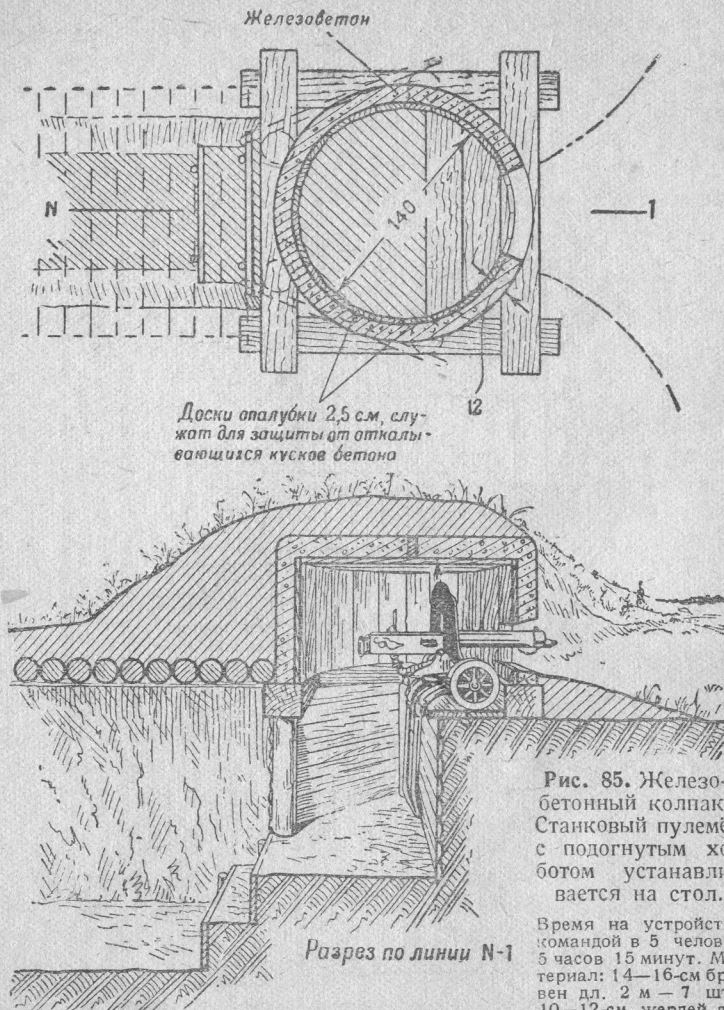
Железобетонный колпак. Станковый пулемёт с подогнутым хоботом устанавливается на стол.
